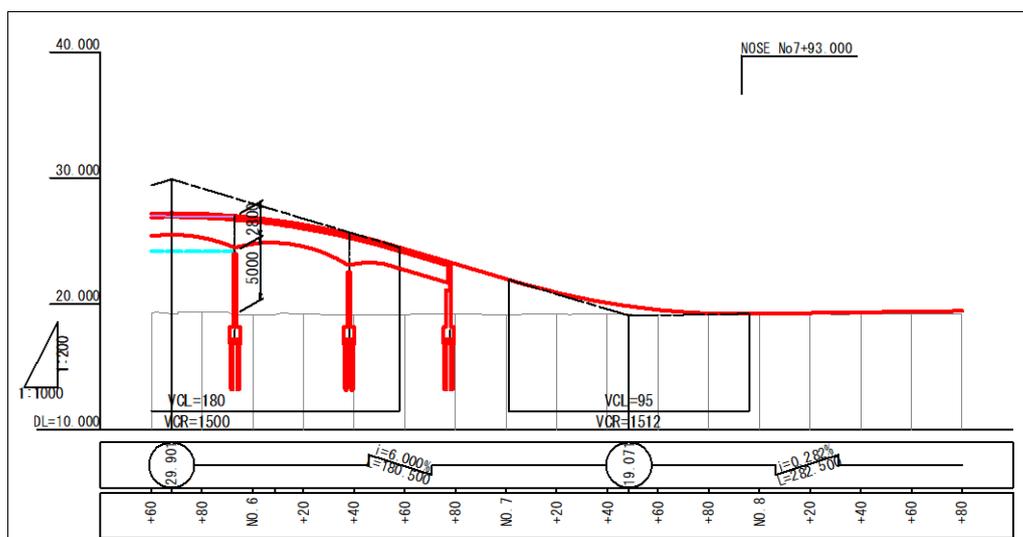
Plan d'implantation du carrefour Riviera 3 (2)
